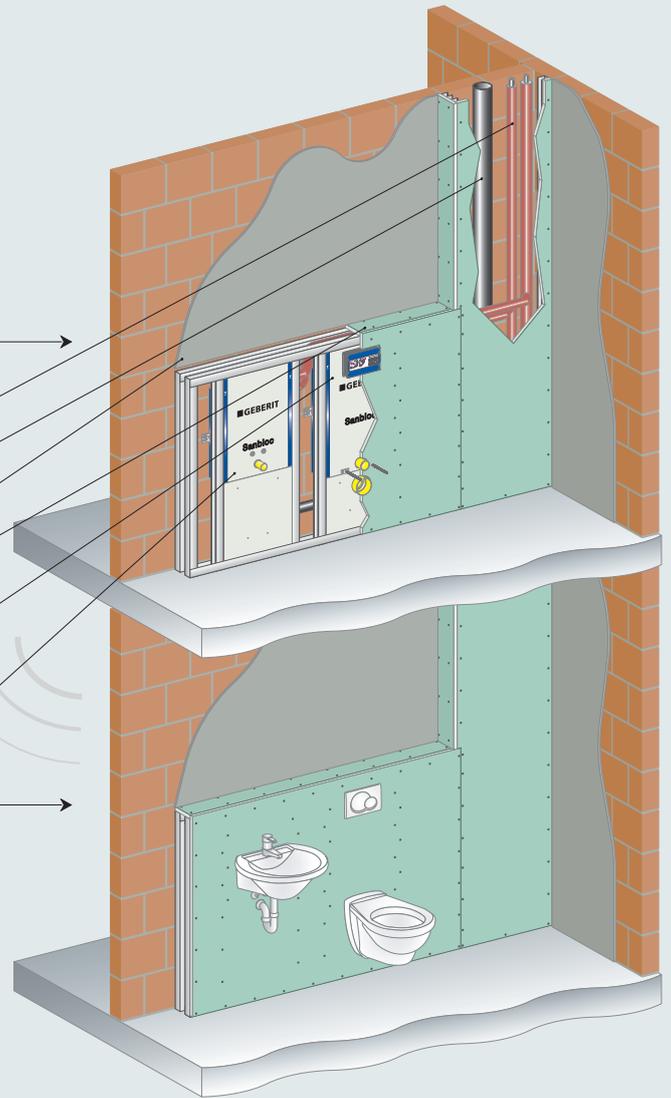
Geberit Sanbloc Installationsbausteine mit Ausmauerung vor einer massiven Trennwand. Schallschnitznachweis nach DIN 4109
